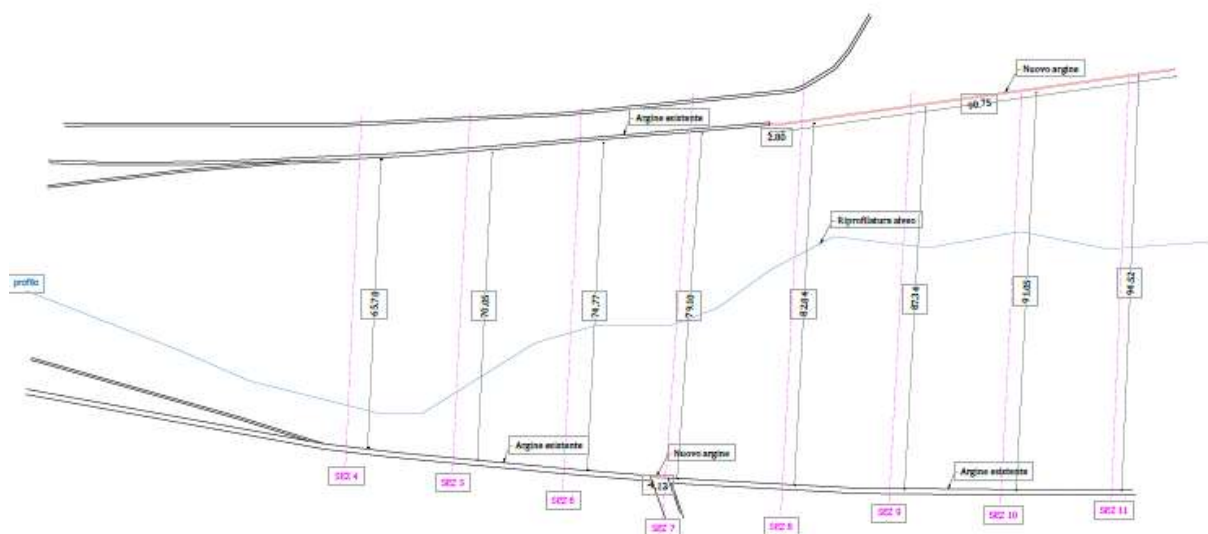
Planimetria ubicazione interventi. 2° Intervento
